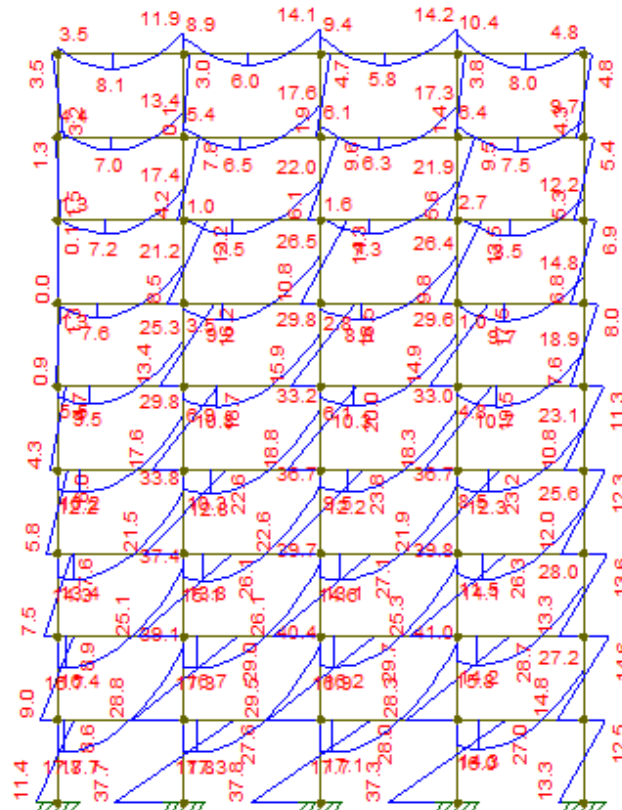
Pórtico contraventado das vigas equivalentes a V201
